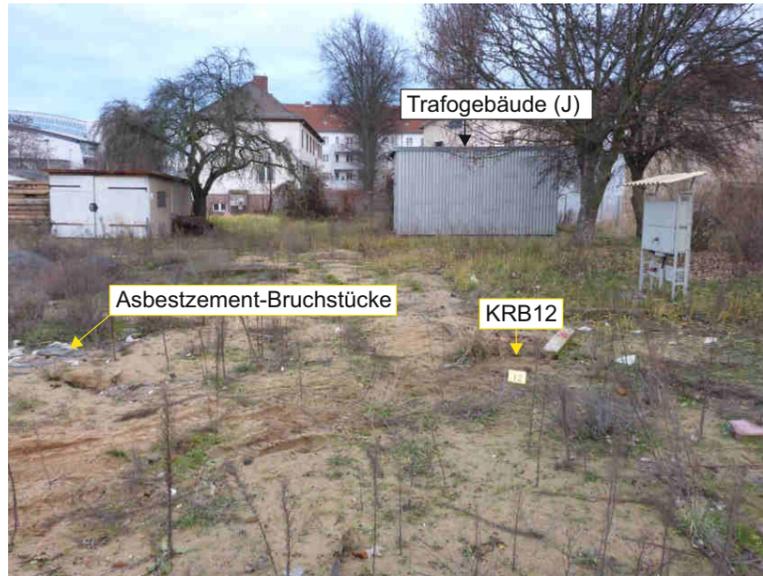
Brachfläche im nordöstlichen Untersuchungsgebiet
